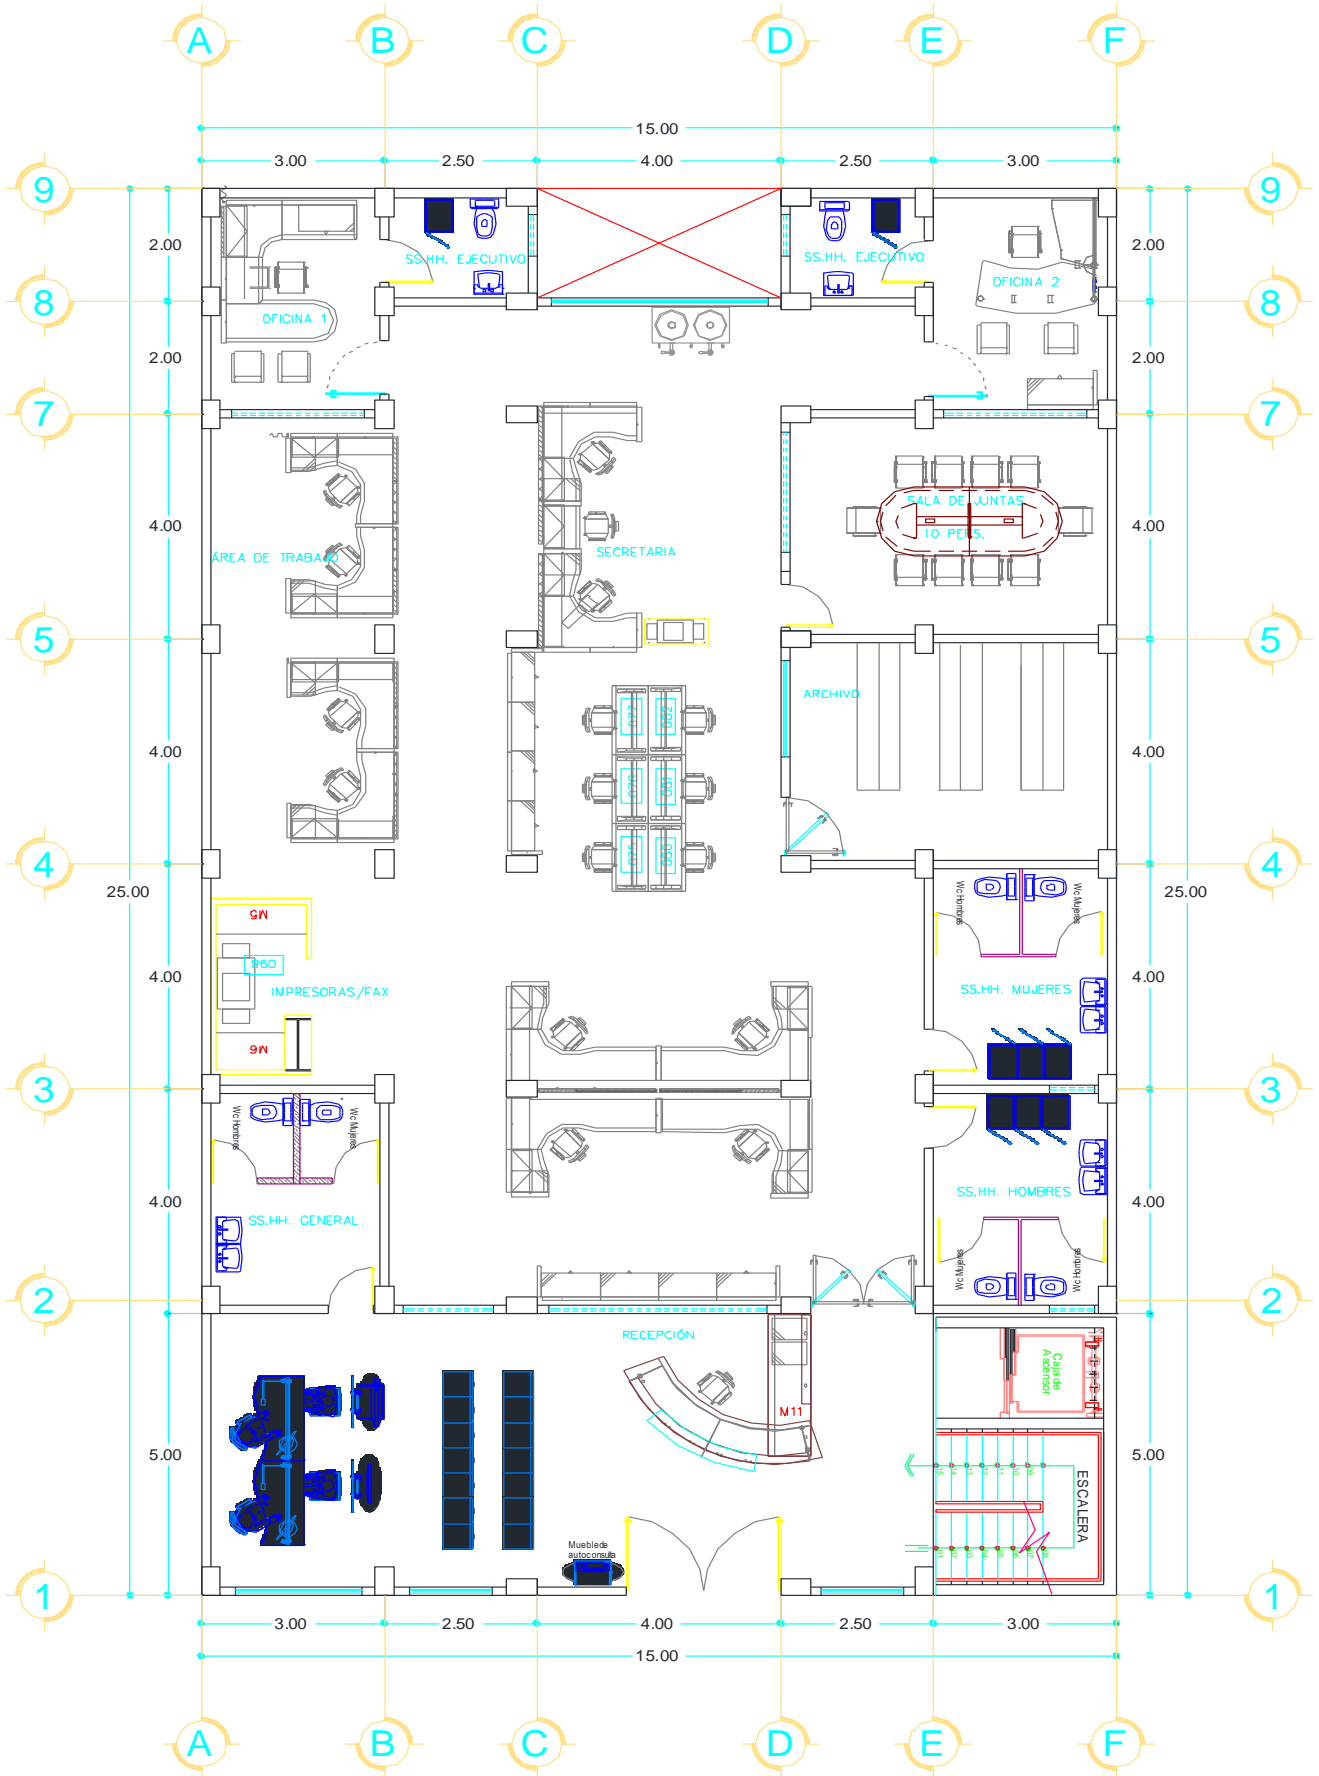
Plano en planta del primer nivel del edificio aparcado.
